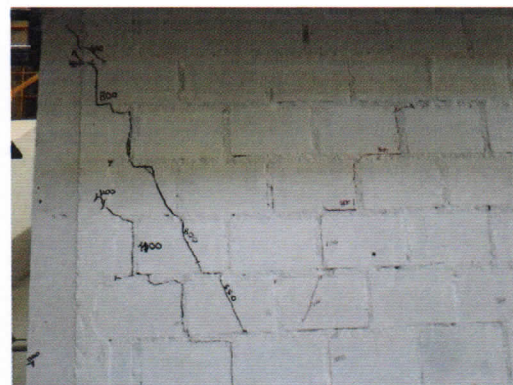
Continuación de grietas para una distorsión 1/550.
